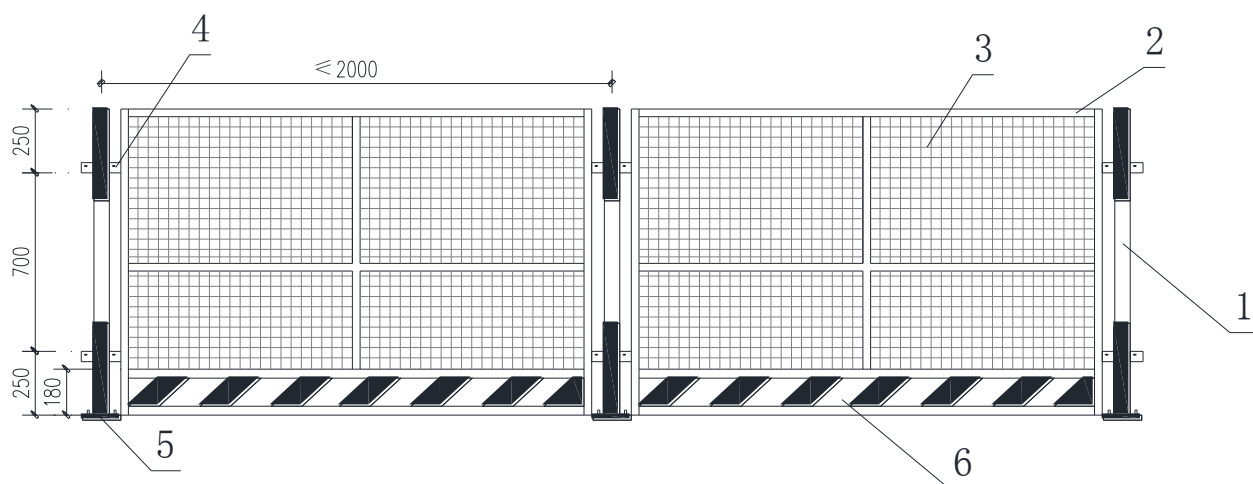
网片式防护栏示意图（单位：mm）
